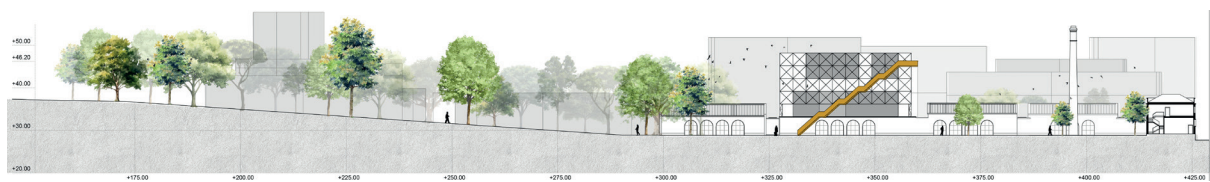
Perfil / Alçado longitudinal Sul, da Fábrica Barros. Realizado no CAD pela autora.
